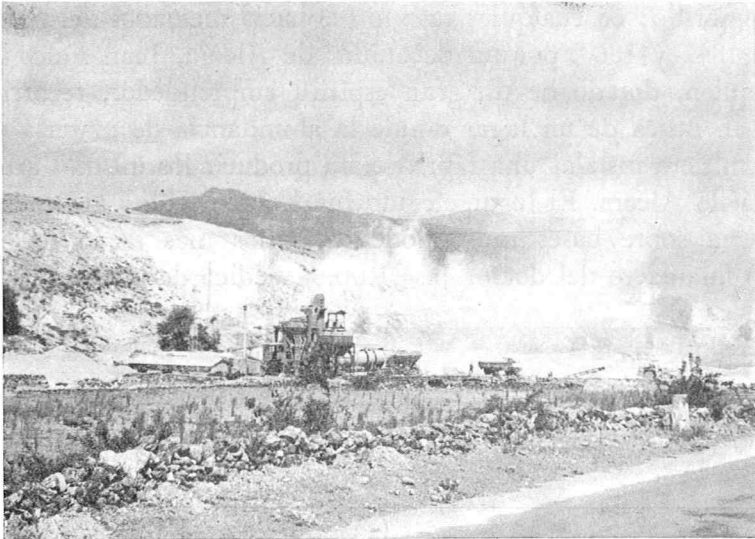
Planta de extracción de áridos en el flanco sur del sinclinal cretácico de Guadalix (carretera de Colmenar Viejo)
